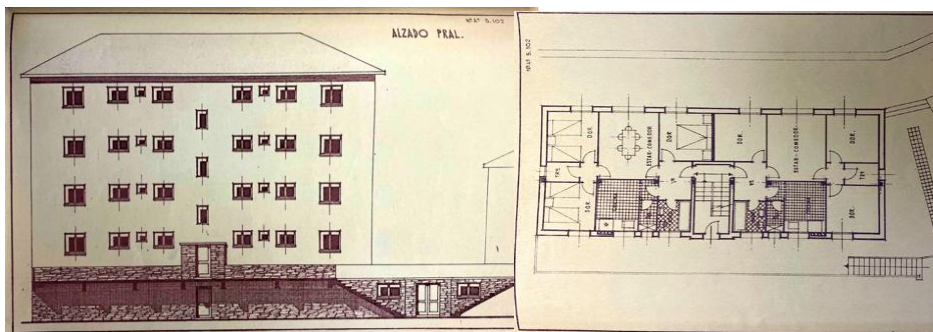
Alzado del bloque de viviendas para los trabajadores del salto de Silvón, construido en Doiras y proyectado por Igancio Álvarez Castelao (Archivo Histórico de Asturias: Colegio de Arquitectos de Asturias, Caja 175600/27).
